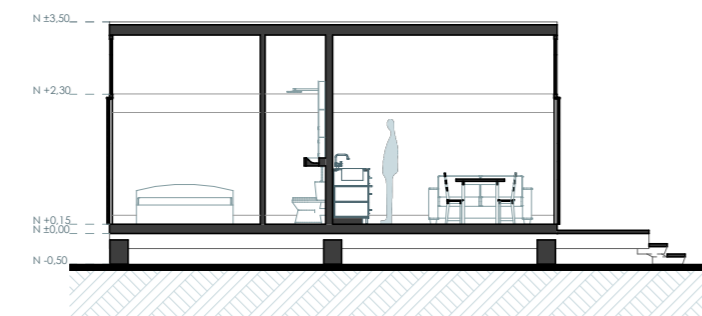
Sección A-A Wikkelhouse. Fuente: Autores, 2023
